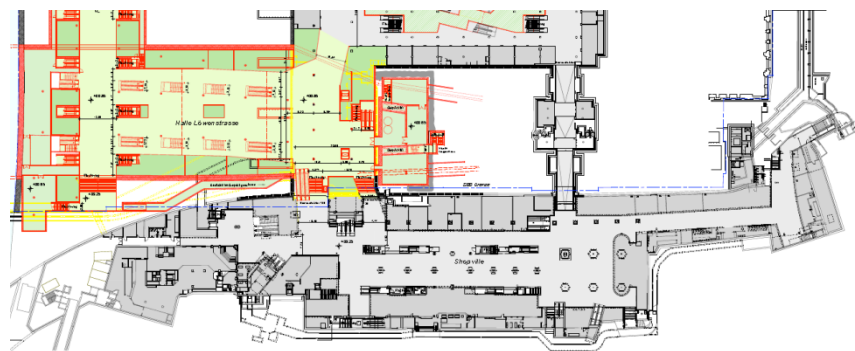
Bauplan der Halle Löwenstrasse Gesamtsicht (Quelle: Dürig)
